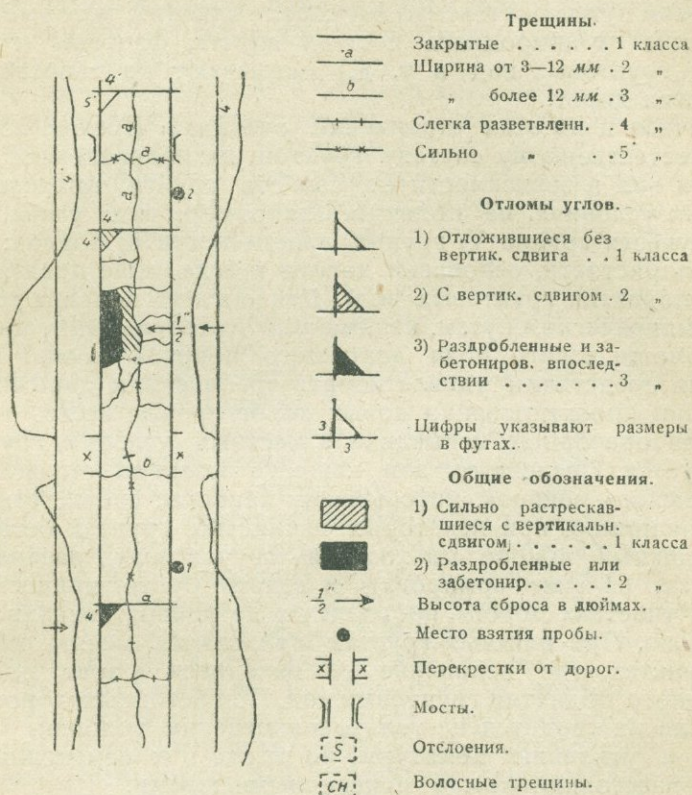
Условные обозначения для повреждений бетонных дорог (по U. S. Bureau of Public Roads) (трещины от растяжения показаны прямыми поперечными линиями).
